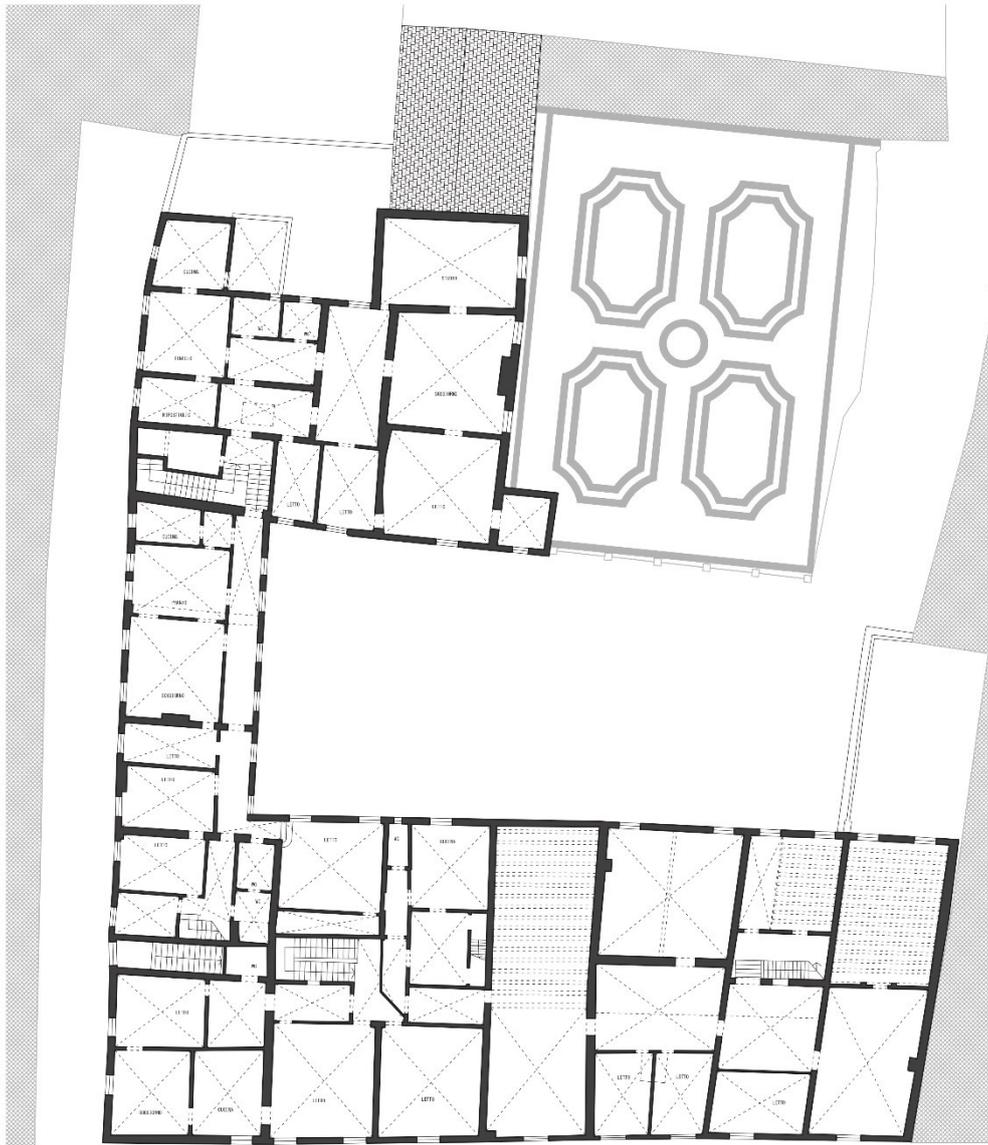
Palazzo Selvatico, Padova, via Vescovado. Pianta del secondo piano.
